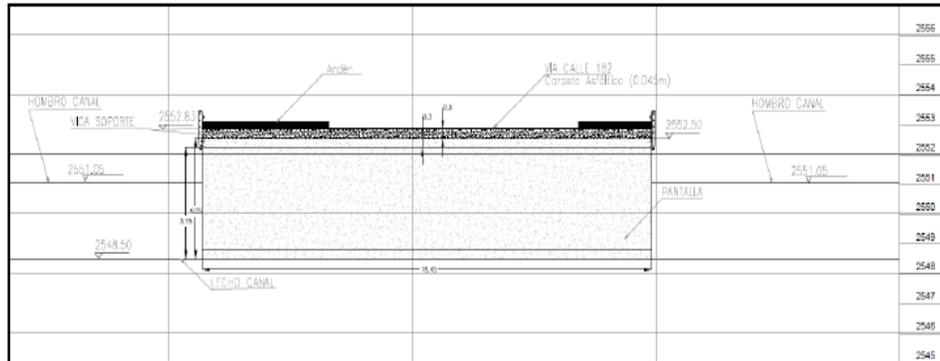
Perfil transversal de box couvert a reforzar en el canal Torca a la altura de la Diagonal 182.
